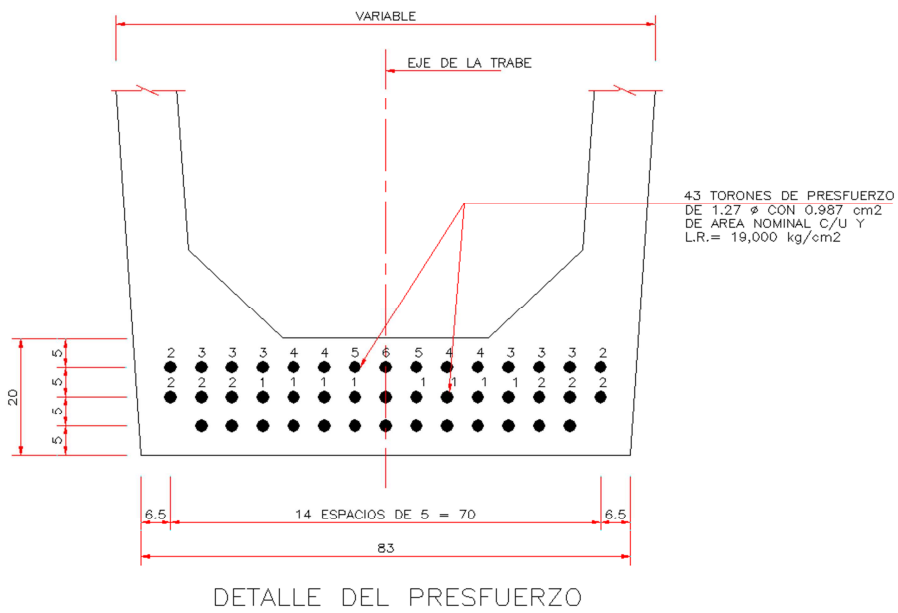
Sección transversal, trabe tipo cajón. Presfuerzo
